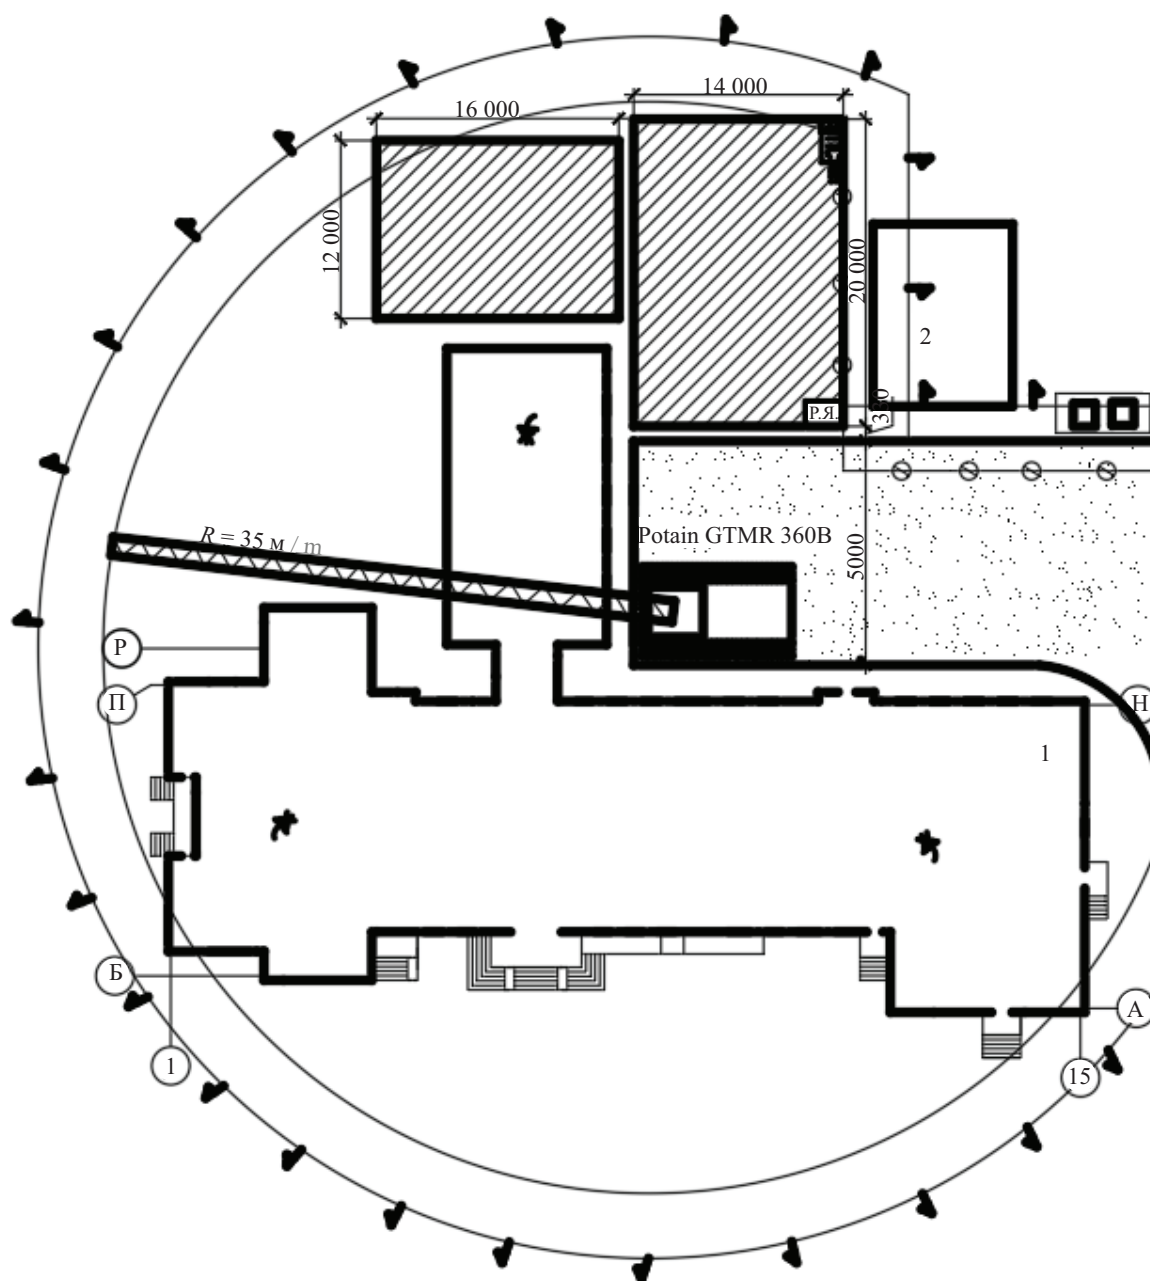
Фрагмент строительного генерального плана возведения школы самомонтирующимся башенным краном Potain GTMR 360B
